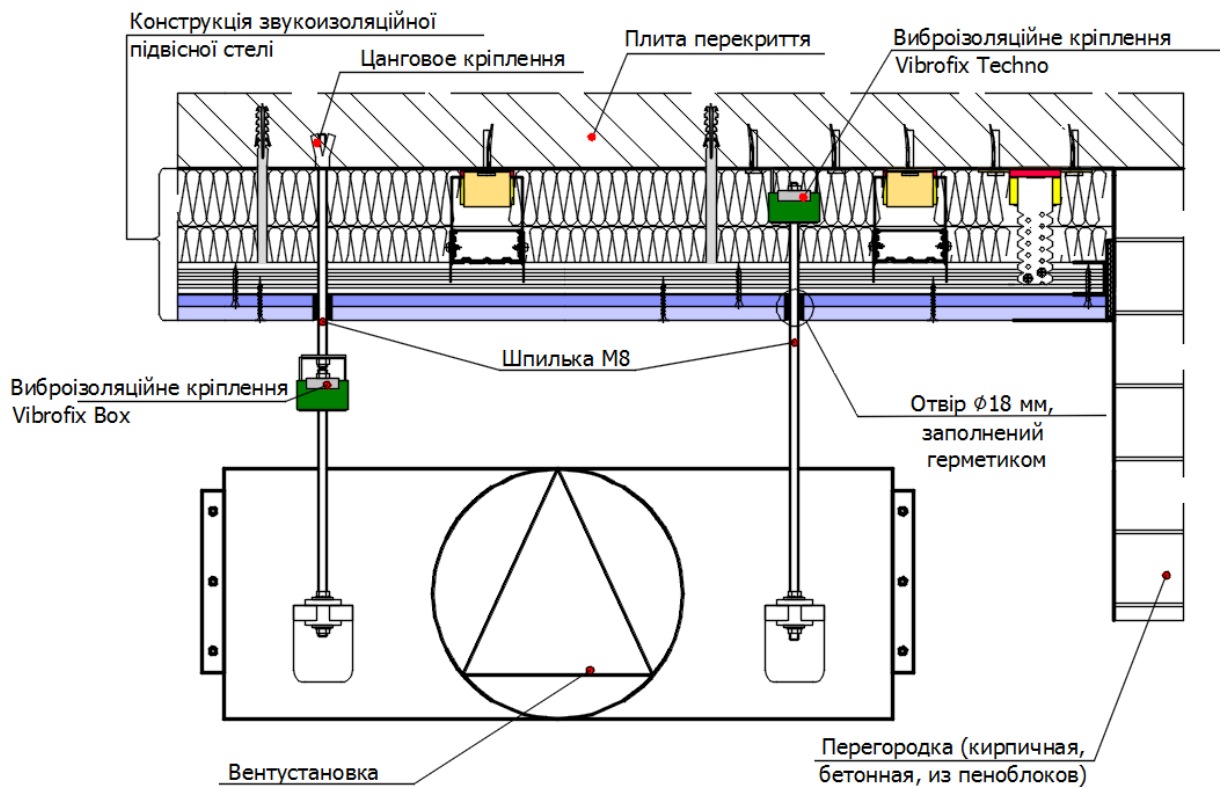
Схема підвісу вентиляційного обладнання до міжповерхової плити перекриття.
